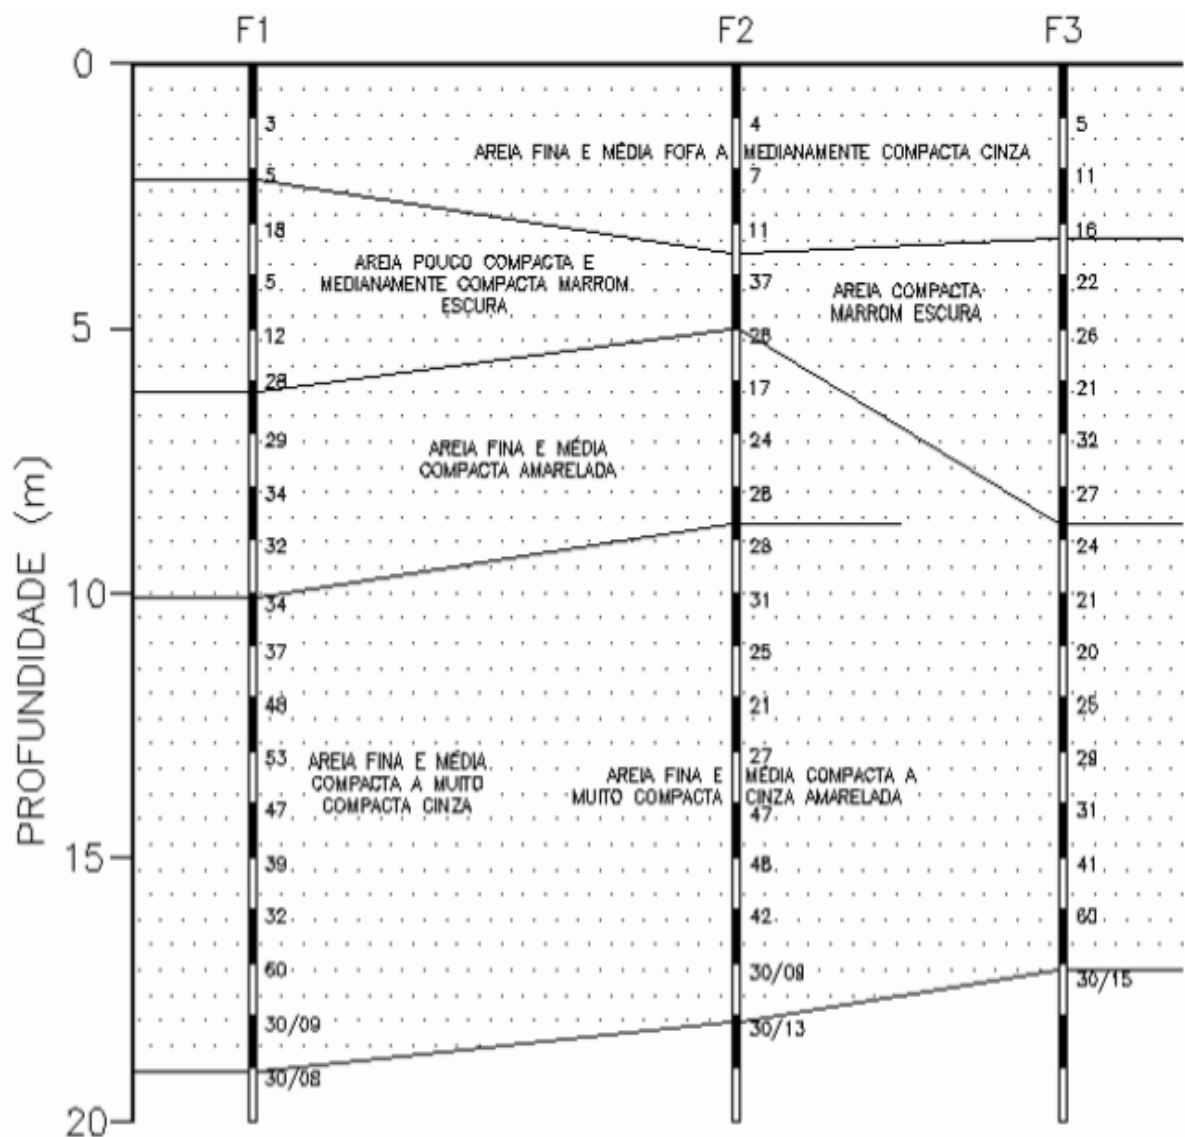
Perfil geotécnico do local da obra (BRAUNE et al 2008)
